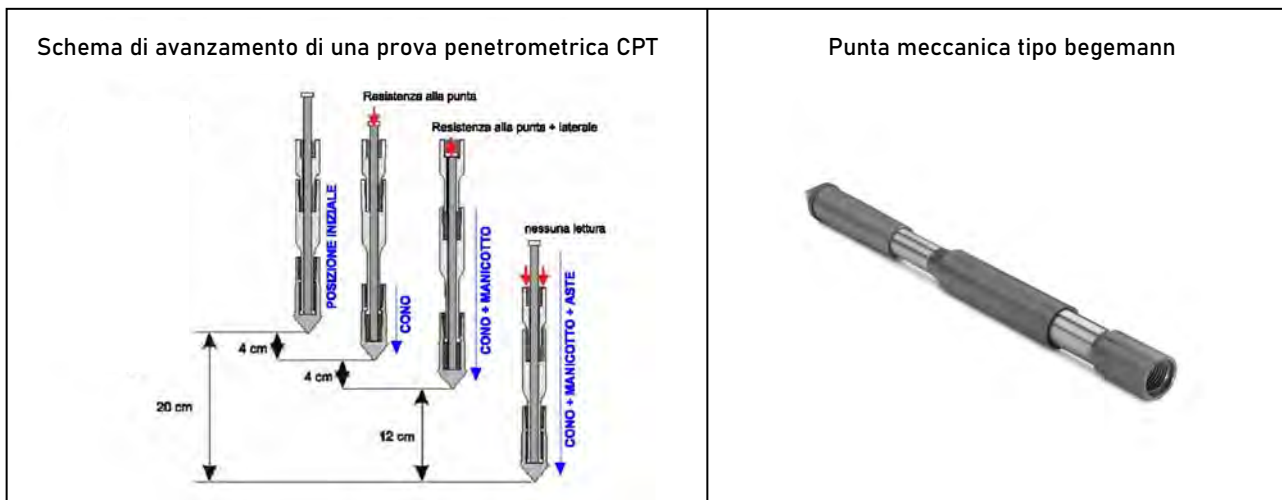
Punta meccanica tipo Begemann e schema di avanzamento.
